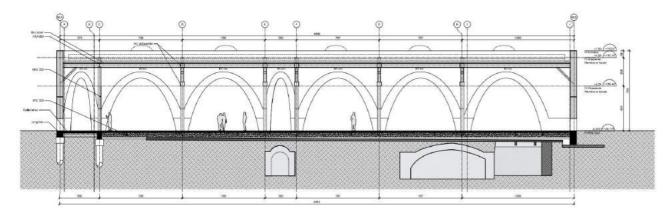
figuration des fondations du bâtiments au regard des caves (coupe longitudinale). Studiolada
